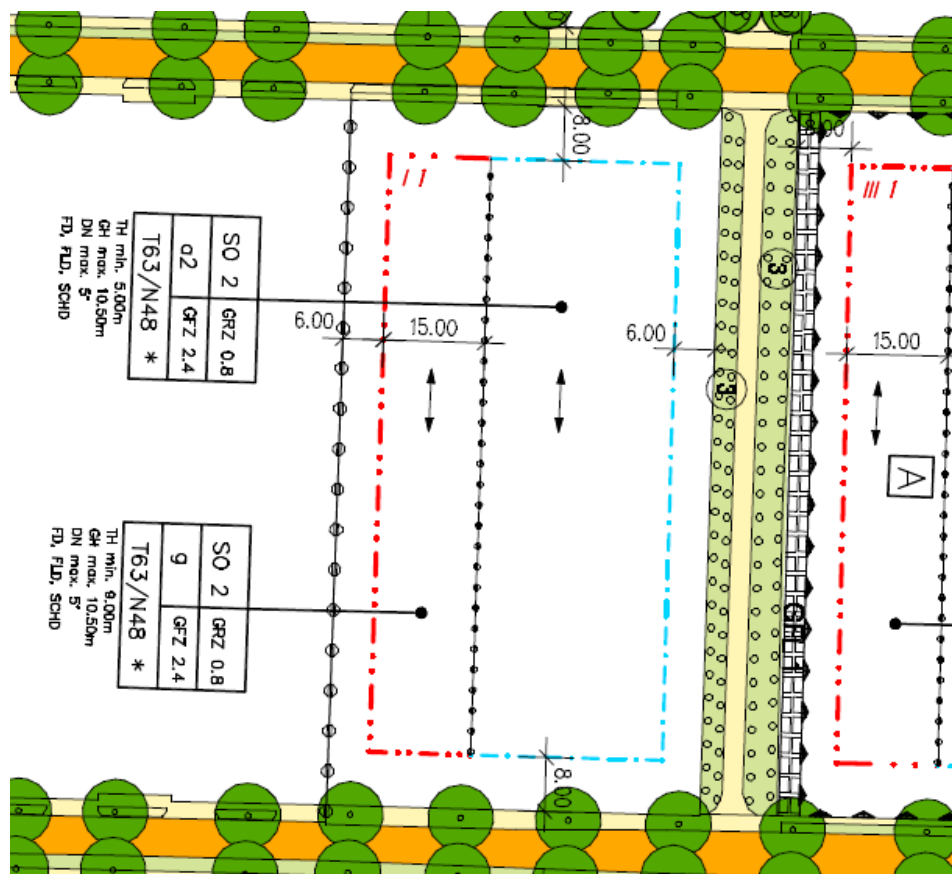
Ausschnitt aus rechtskräftigem Bebauungsplan „D9-Änderung“, Gewerbepark ‚Am Messengelände‘, freier Maßstab
